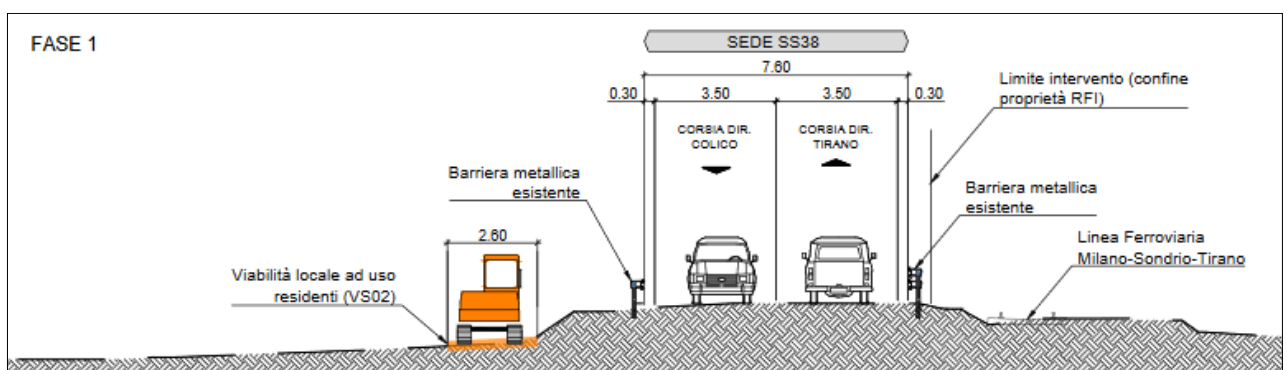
Allargamento sede stradale e nuova strada locale parallela, fase 1
